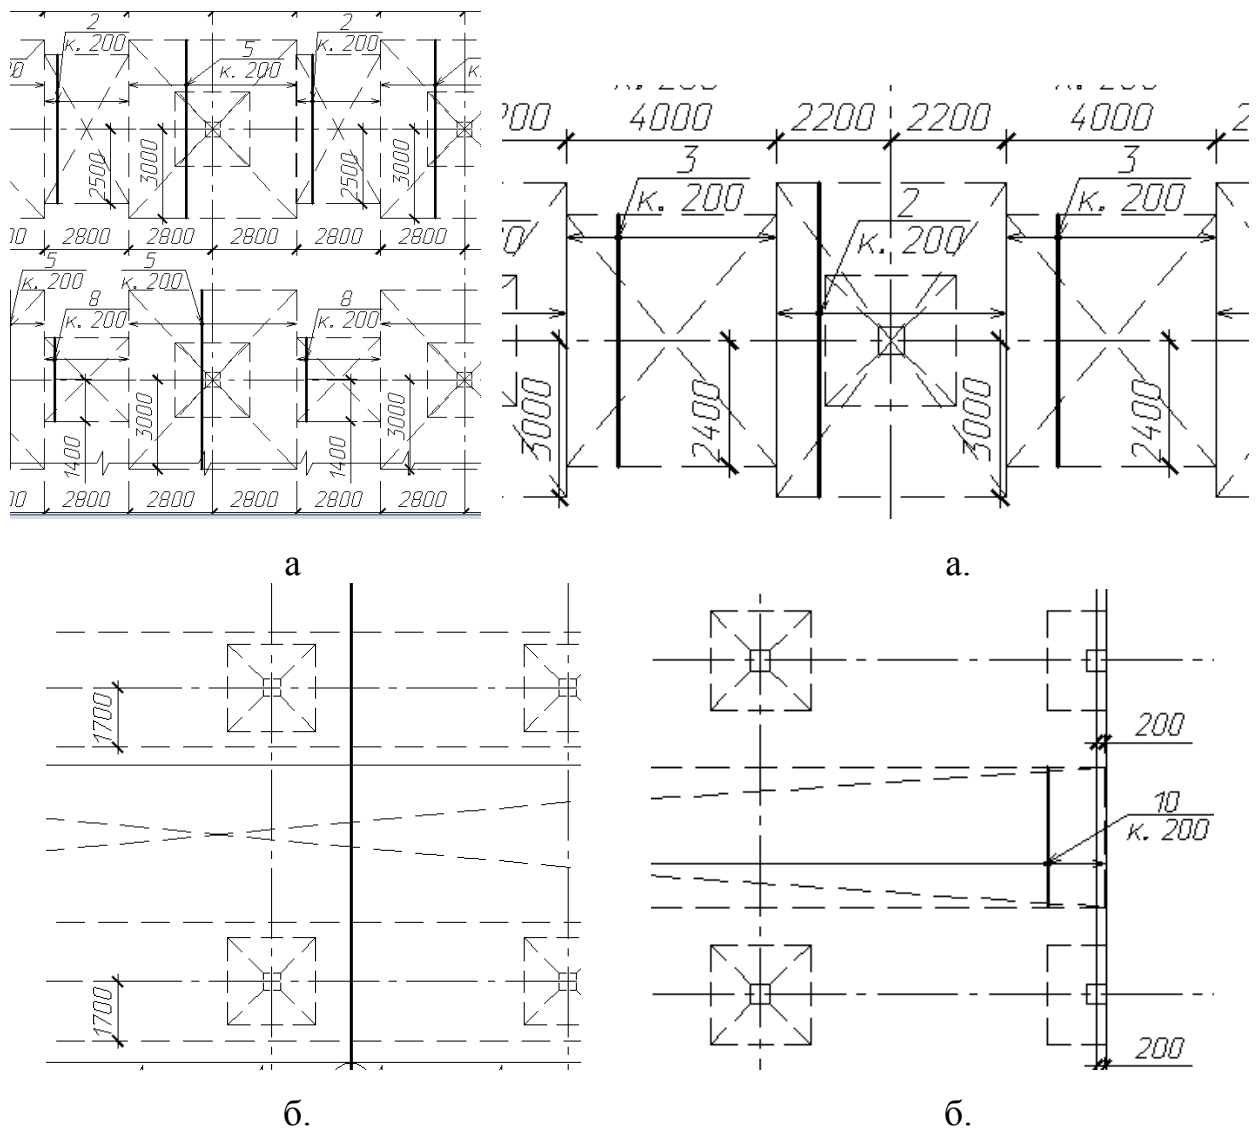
Схема армування плити нижнього ярусу: а - верхня арматура; б - нижня арматура
